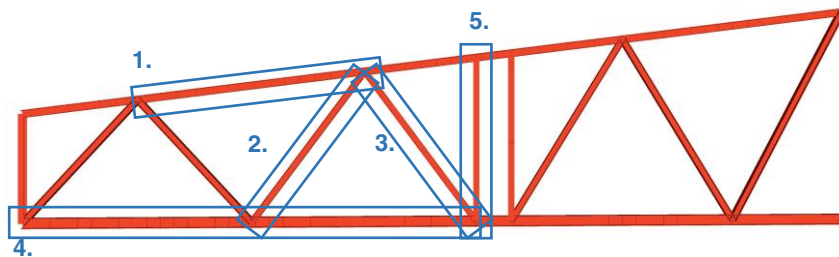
Viga en celosía 3. Barras que fallan.
